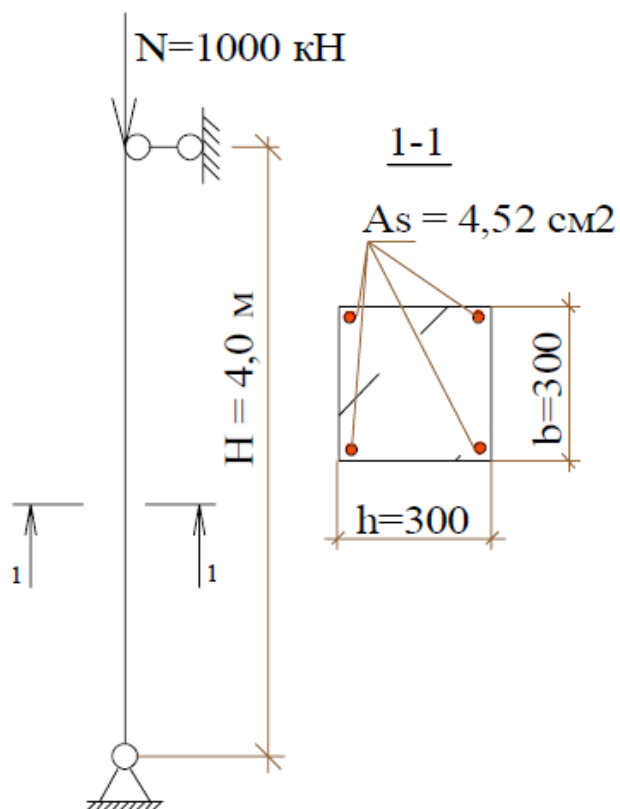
Расчетная схема железобетонной колонны до усиления
